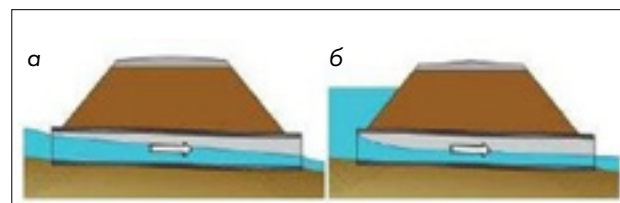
Работа водопропускного трубопровода в безнапорном (а) и полунанпорном (б) режимах
